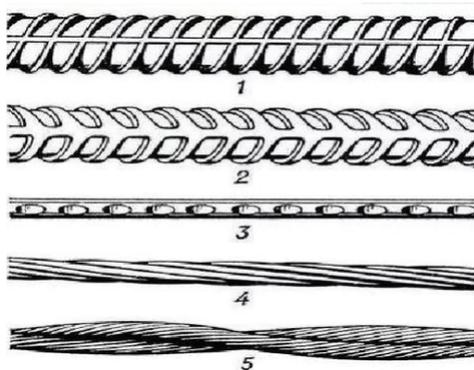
Стальная арматура железобетонных конструкций:
